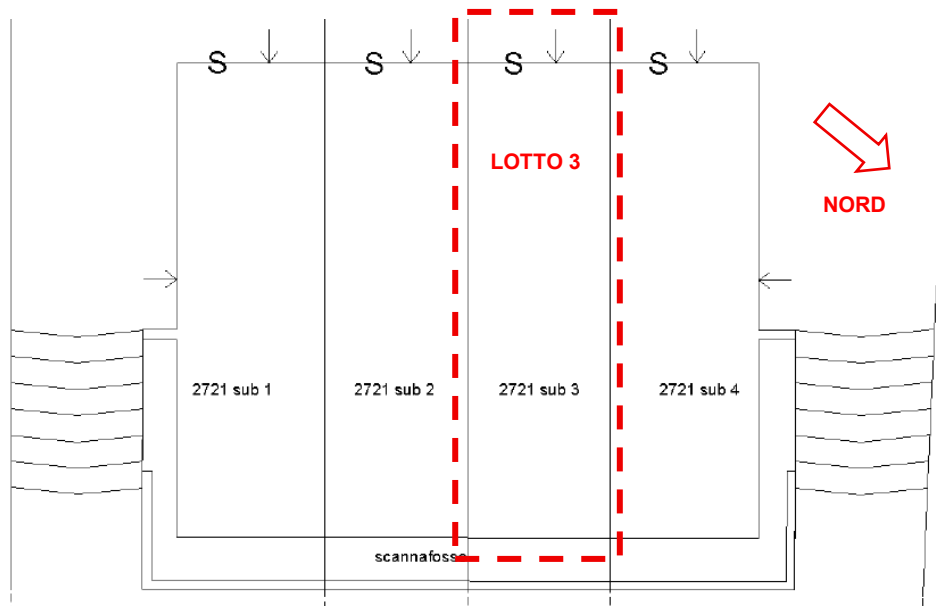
Stralcio dell'elaborato planimetrico (Piano S1, fuori scala)
